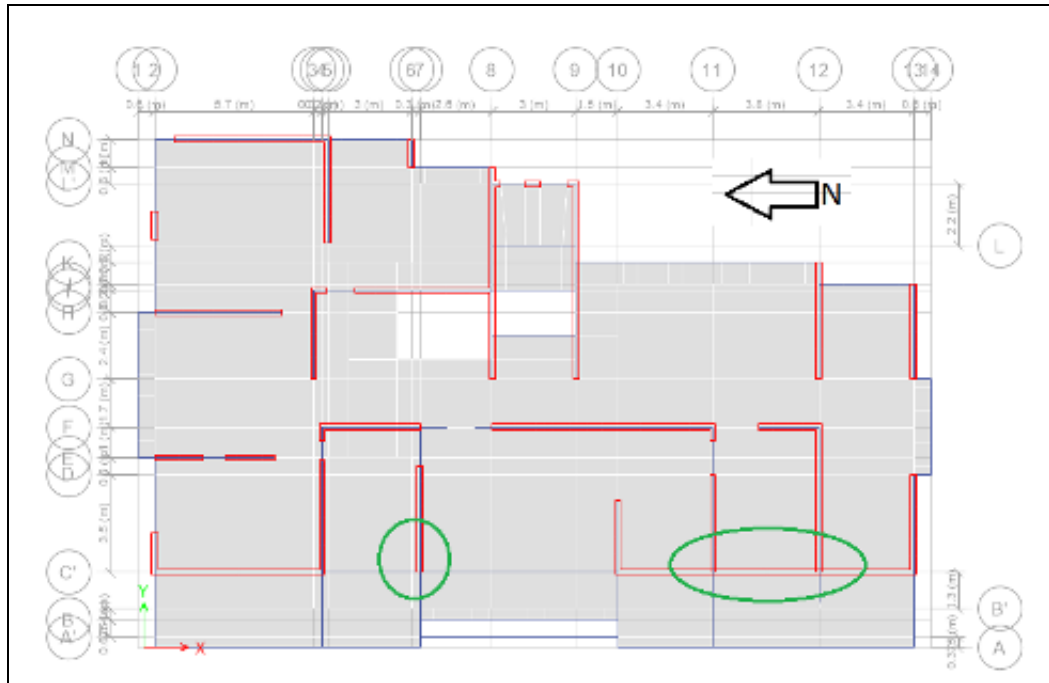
Planta del piso 1 del edificio M8, se indican los elementos dañados M8-2 y M8-1 respectivamente
